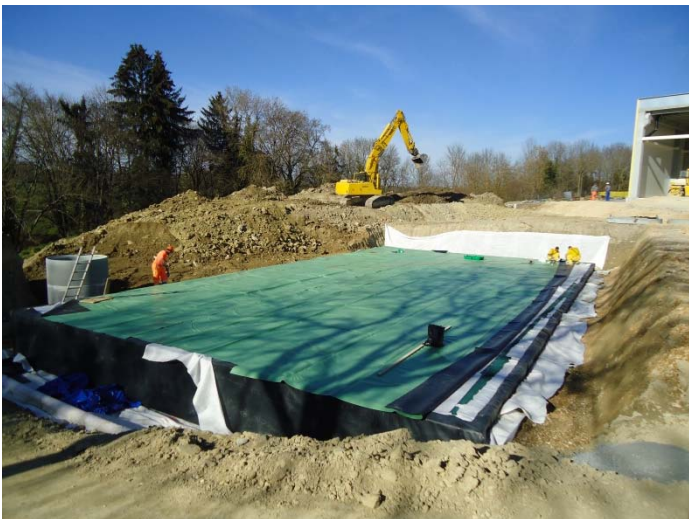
Installazione dei moduli Rigofill® su due piani
